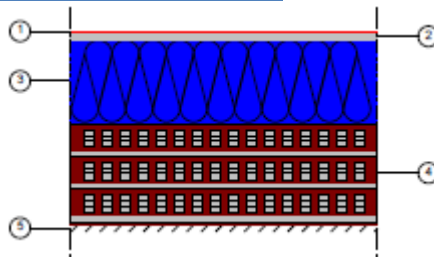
Detalle constructivo de los componentes de la cubierta tipo 1 tras la mejora.
